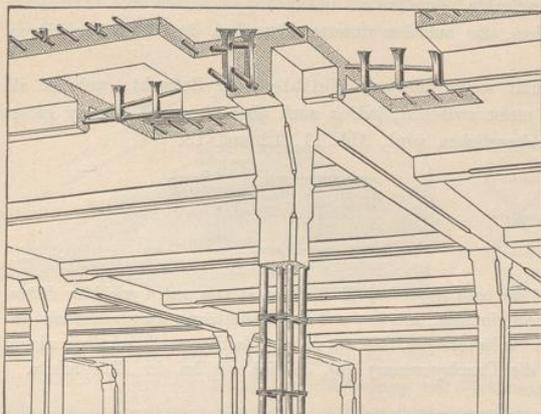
Decke nach dem Systeme Hennebique, etwa seit 1898 auch in Deutschland verbreitet. Die Verbindung der Rundeisen mit dem Beton zu Trägern, in denen durch den Widerstand des Cements gegen Druck im oberen Theile der Trägermitten und des Eisens gegen Zug im unteren Theile der Trägermitten hänge- und sprengewecksartige Beanspruchungen entstehen. Die Stützen der Träger sind ähnlich aus Rundeisen und Cementbetonumhüllung herzustellen.
